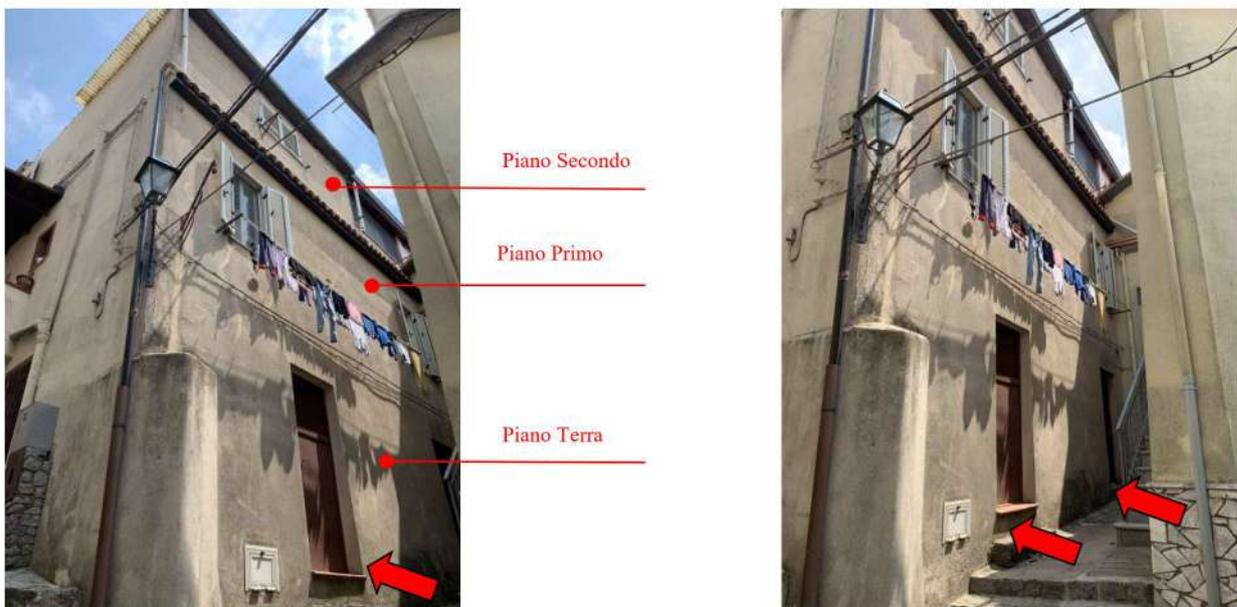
IMMOBILE – INGRESSO PIANO TERRA AI LOCALI DEPOSITO.
